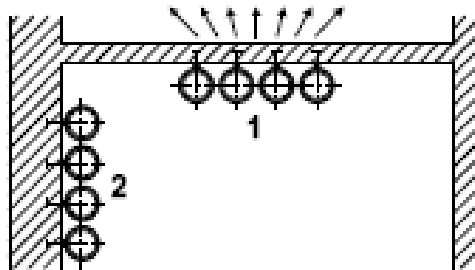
Posizionamento delle tubazioni errato, su parete sottile al centro; corretto, su parete spessa nell'angolo staticamente rinforzato.
